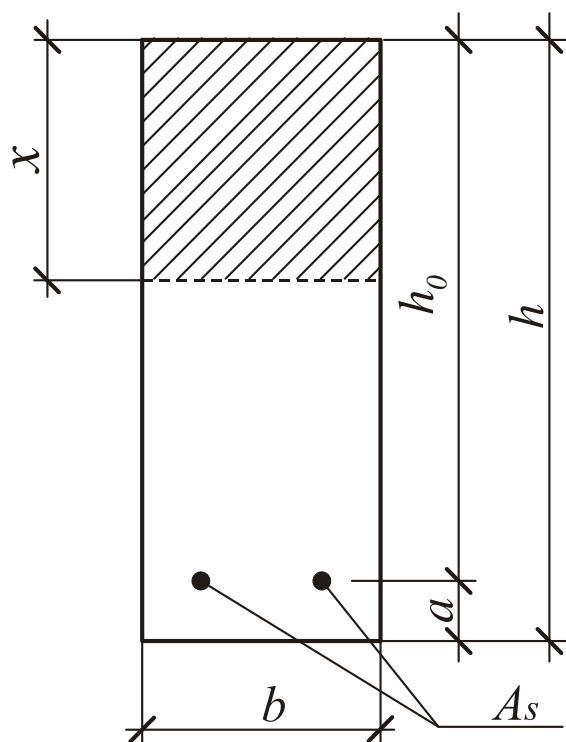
Расчетное поперечное сечение изгибаемого железобетонного элемента прямоугольного профиля с одиночным армированием
